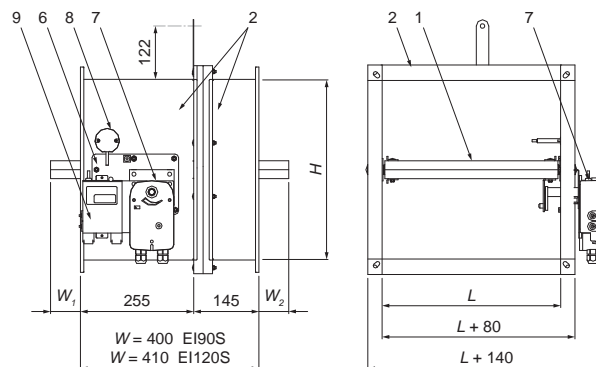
Конструкция противопожарного клапана с электромеханическим приводом для размеров из табл. 3
